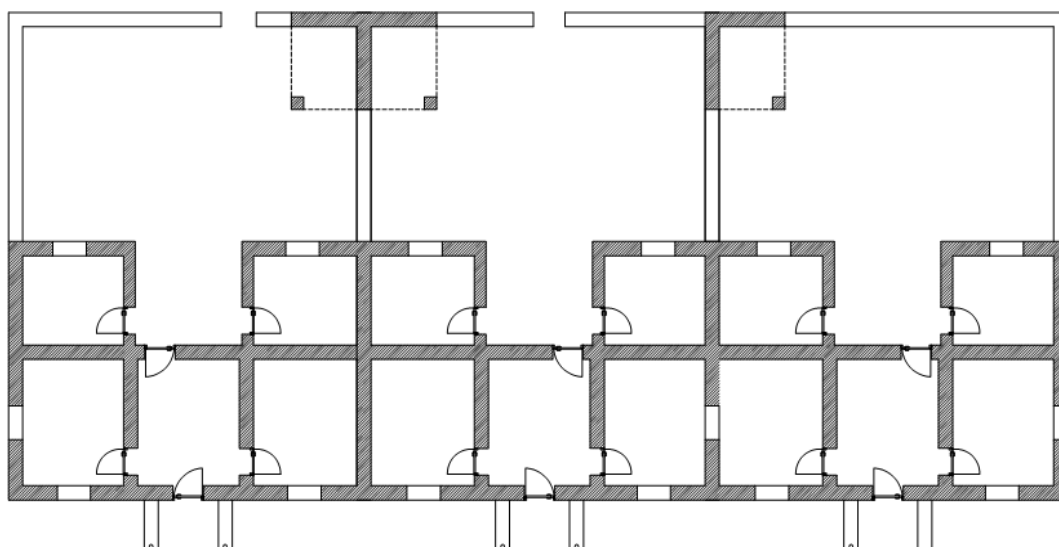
Planta de Aquartelamento dos guardas auxiliares
